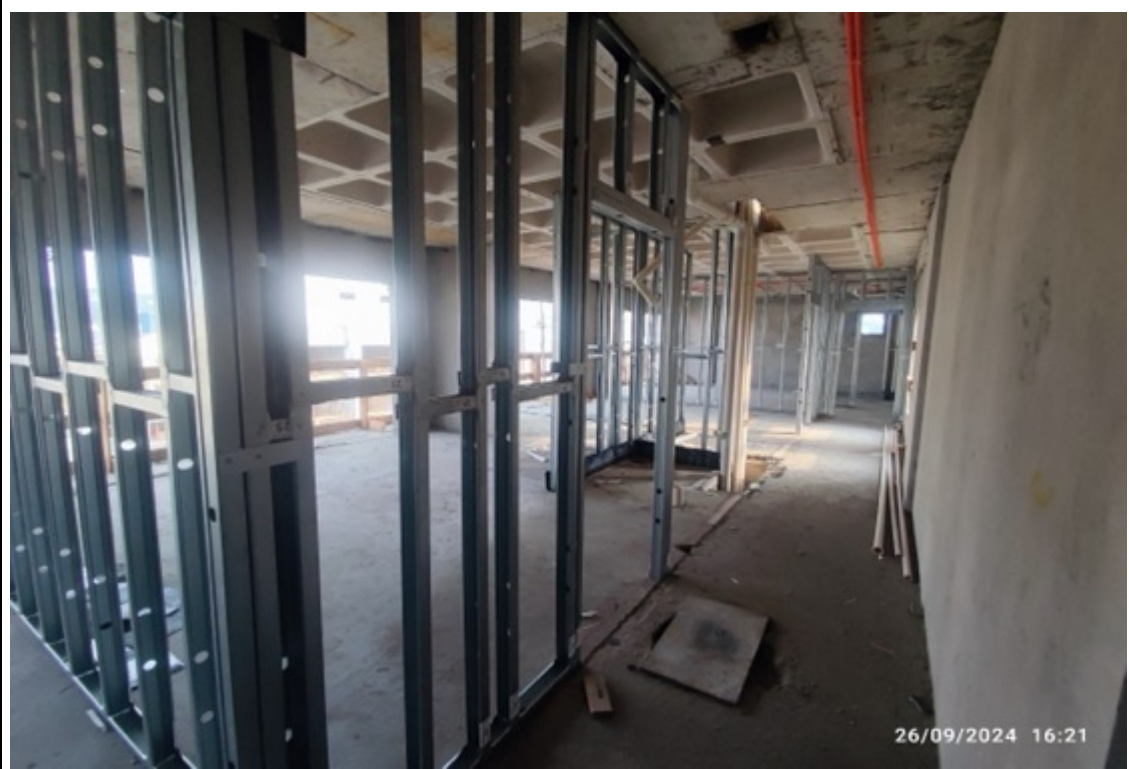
Montagem de estrutura de drywall das paredes das suítes
